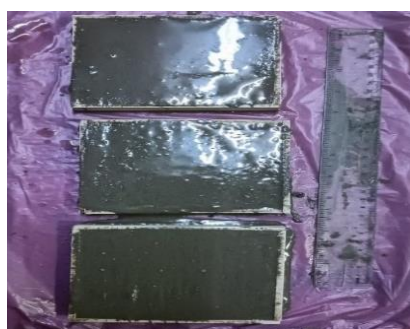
Muestras de Hormigón 100x100x14.9mm.
